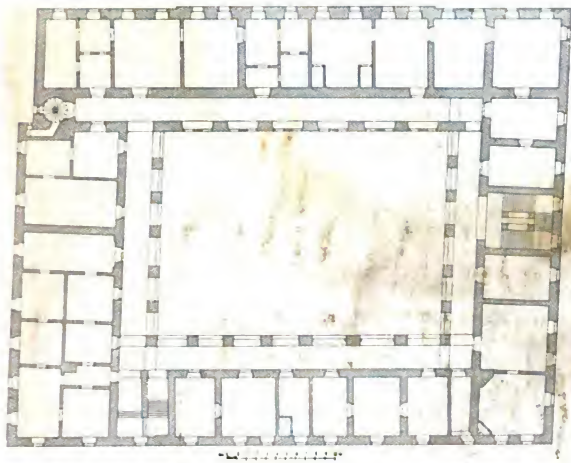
Byszitz. Grundriss des Schlosses.
